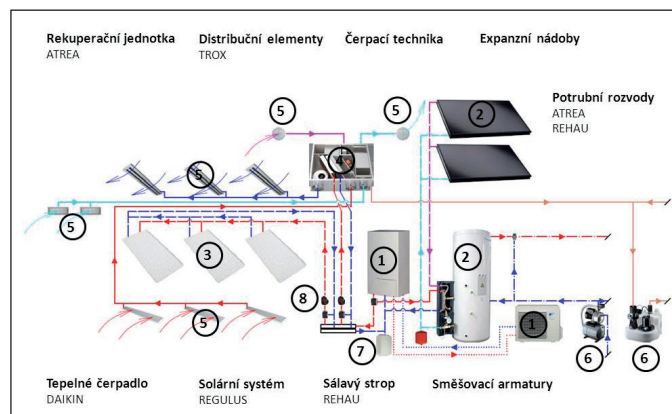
AIR HOUSE, zdroj: AIR HOUSE
